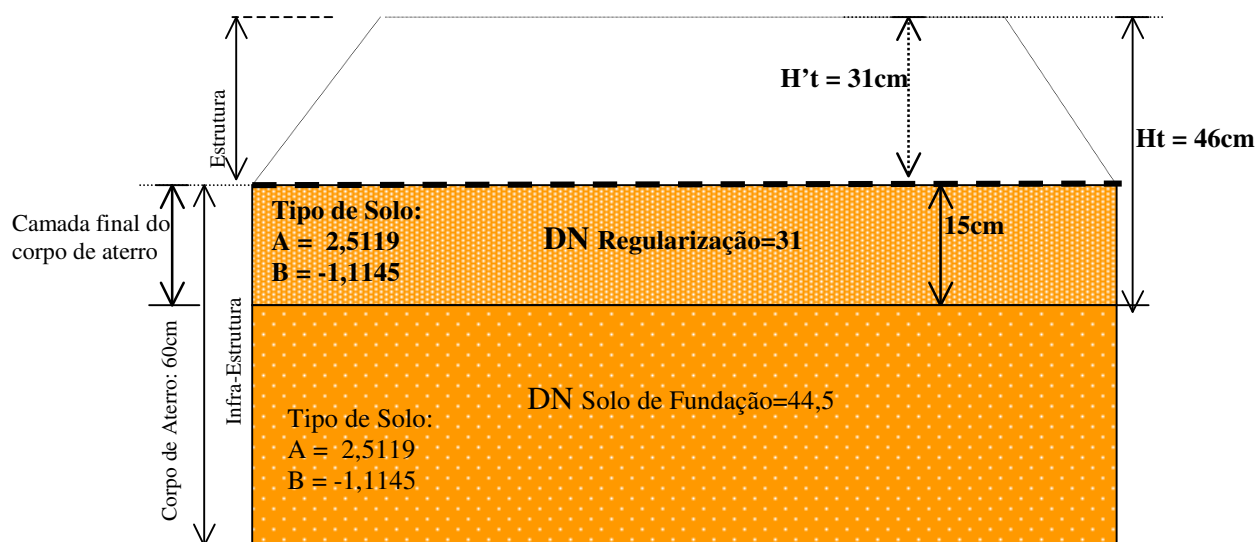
Esquema da estrutura do pavimento após compactação da camada final de aterro (PMSP/92).
